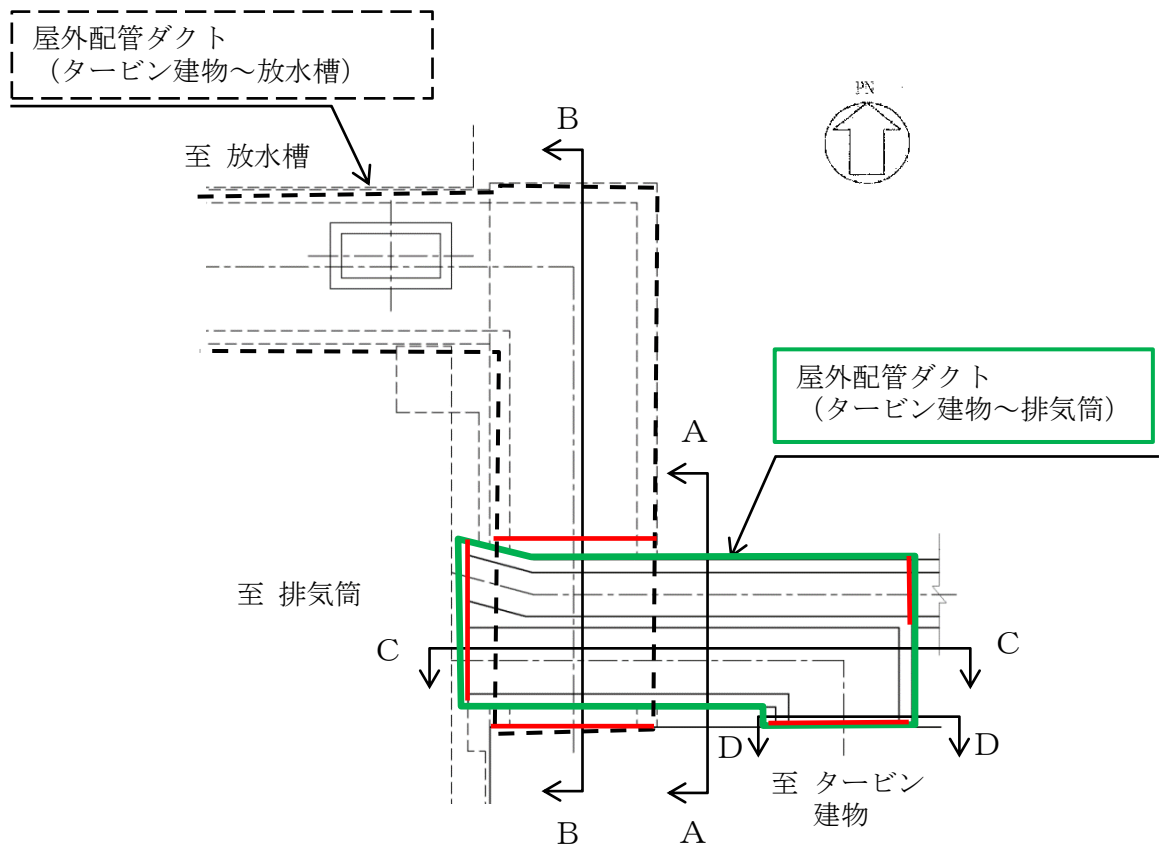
屋外配管ダクト (タービン建物～排気筒) 平面図
